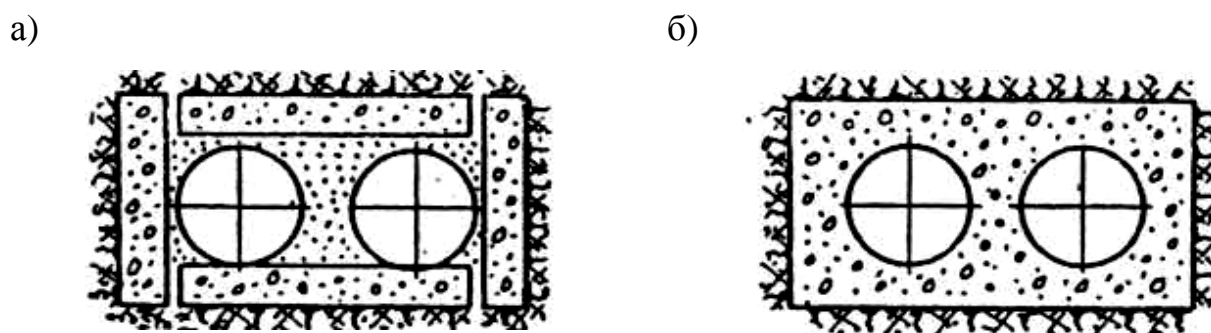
Разрез безканального теплопровода в литом пенобетонном массиве:
